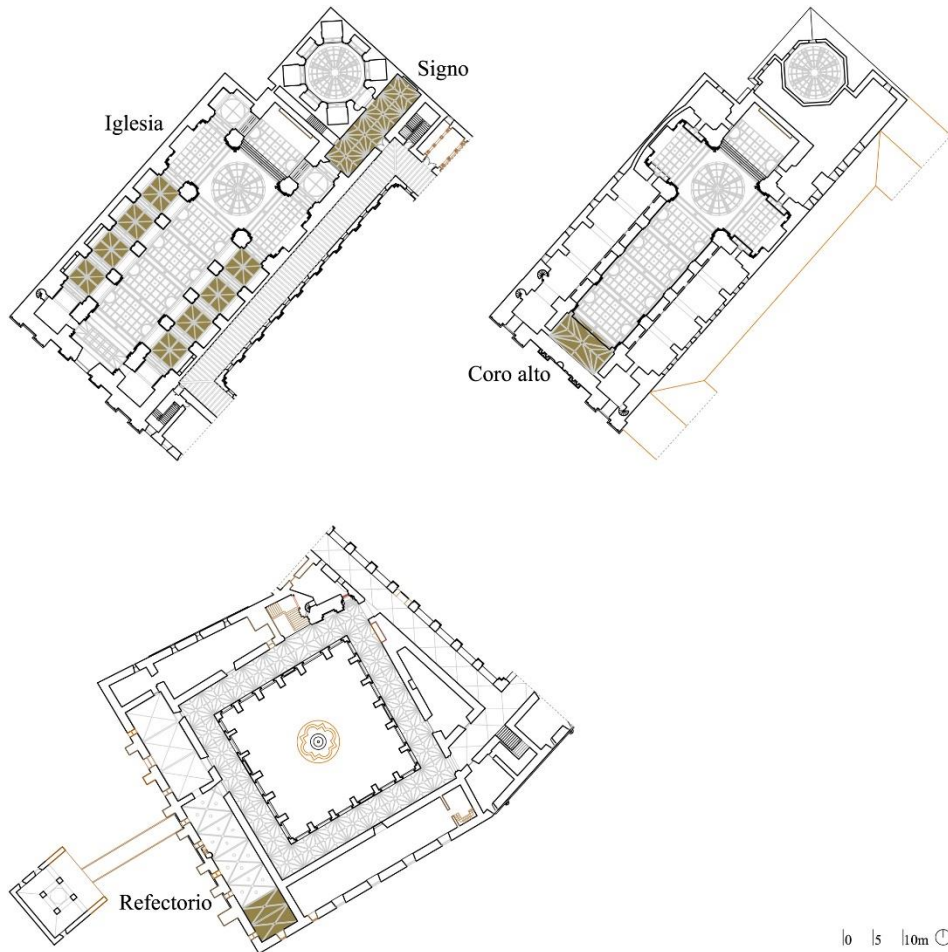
De izquierda a derecha y de arriba abajo, planta primera de la iglesia, planta a la altura del coro alto de la iglesia y planta baja del claustro de las Nereidas del monasterio de San Julián de Samos señalando las bóvedas de crucería construidas durante los siglos XVII y XVIII sobre los dos últimos tramos del refectorio de monjes, el signo, las naves laterales de la iglesia y el coro alto de la iglesia. Dibujo de la autora
